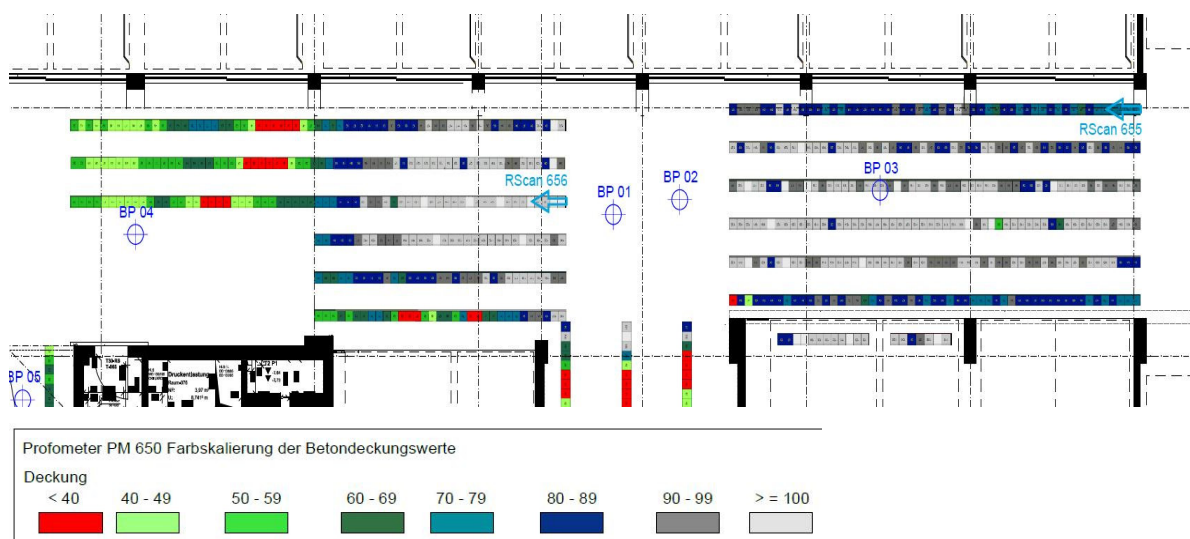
Planauszug der Betondeckungsmessung im Bereich der Fahrgasse 02.UG
